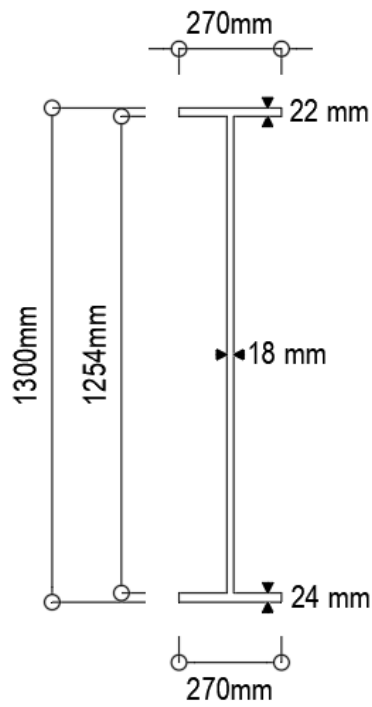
Corte transversal final de la viga interior variantes vigas de acero.
